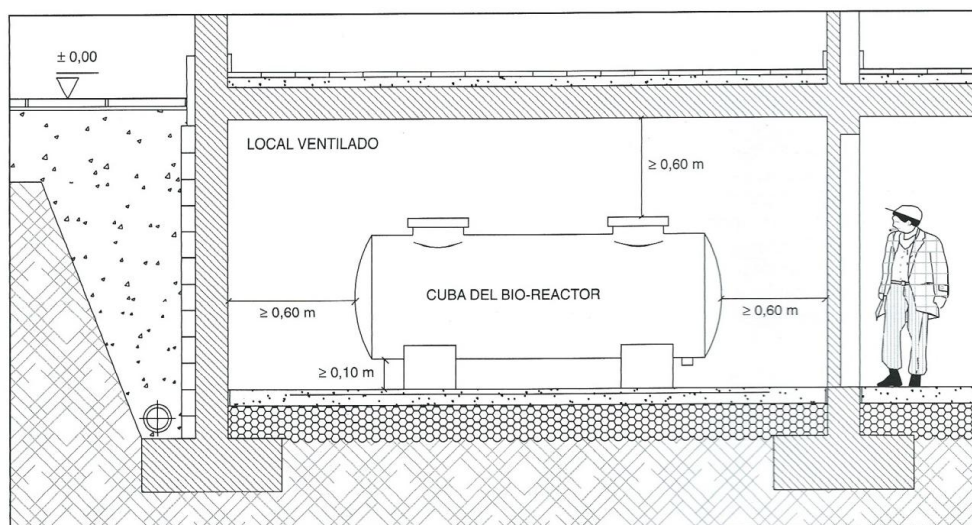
Ubicación en sótano o planta baja dentro del edificio.
